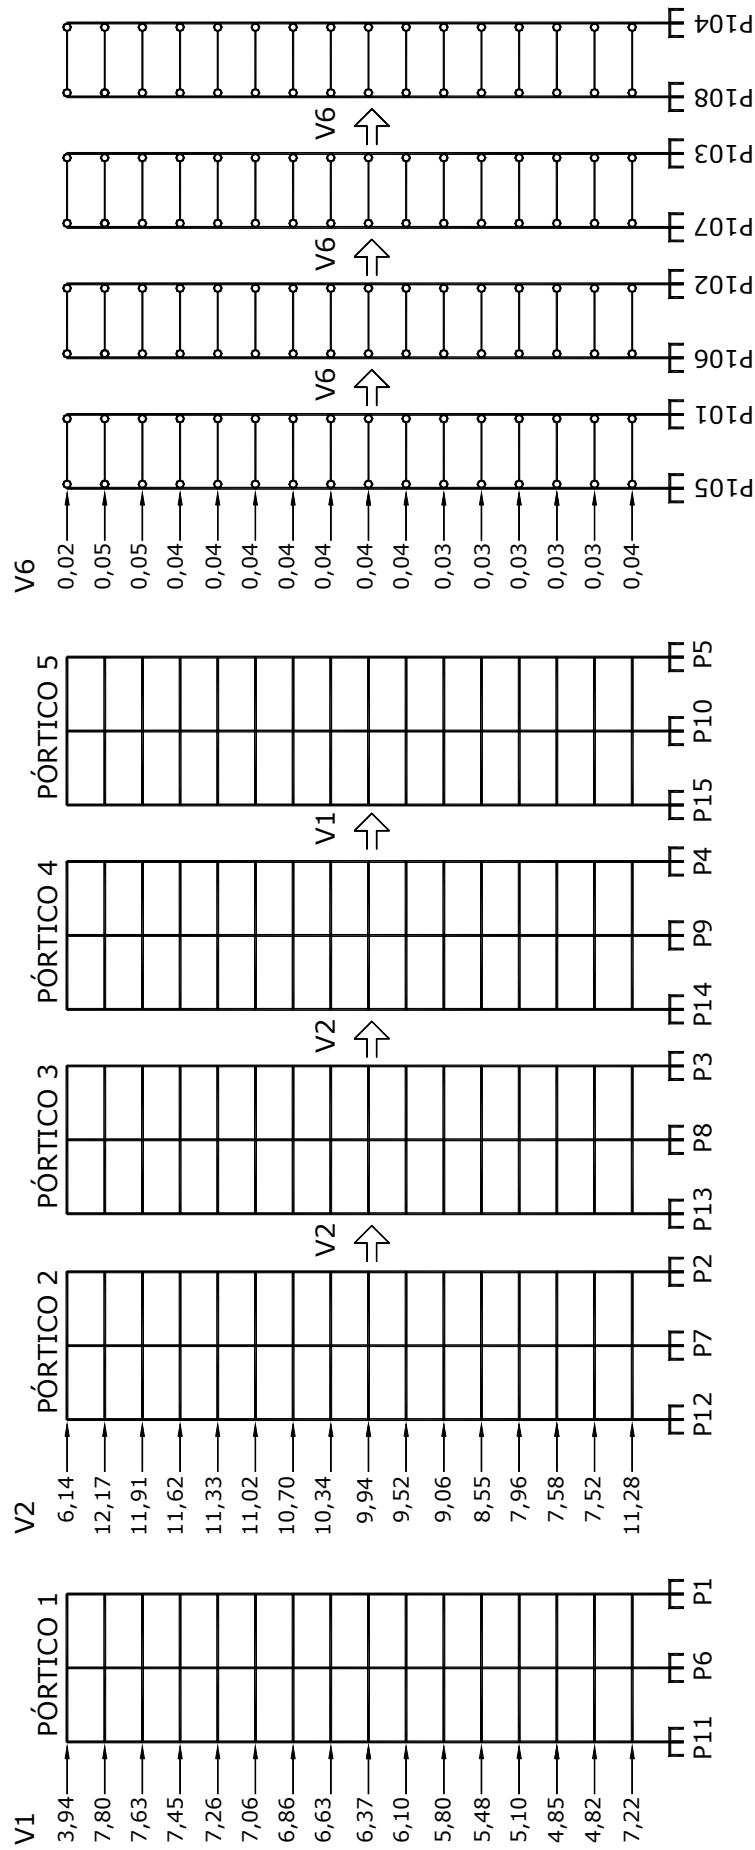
Modelo Pórticos Planos Independentes Compatibilizados no Topo (PPI-CT) da Estrutura 2: elevação dos pórticos e esquema do carregamento (em kN).
